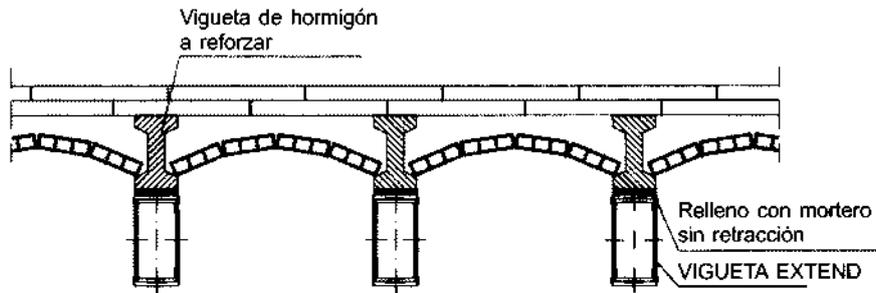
Sección refuerzo. Vigueta de hormigón con revoltón.
